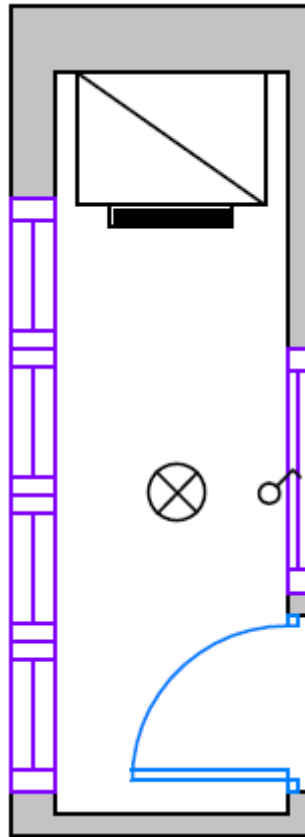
Plano de planta de la terraza. Fuente: Elaboración propia
